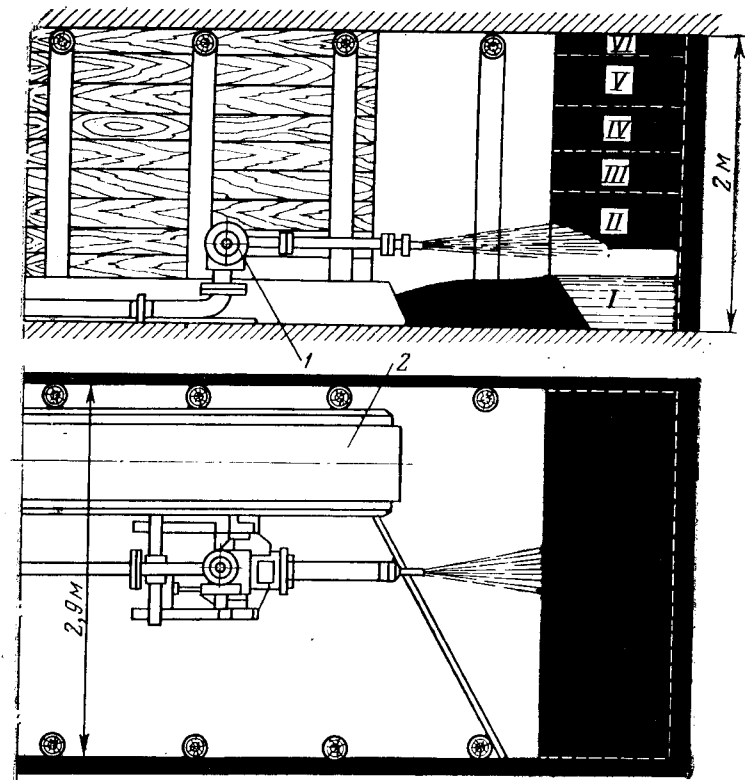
Схема проведения выработок при отбойке угля гидромонитором
